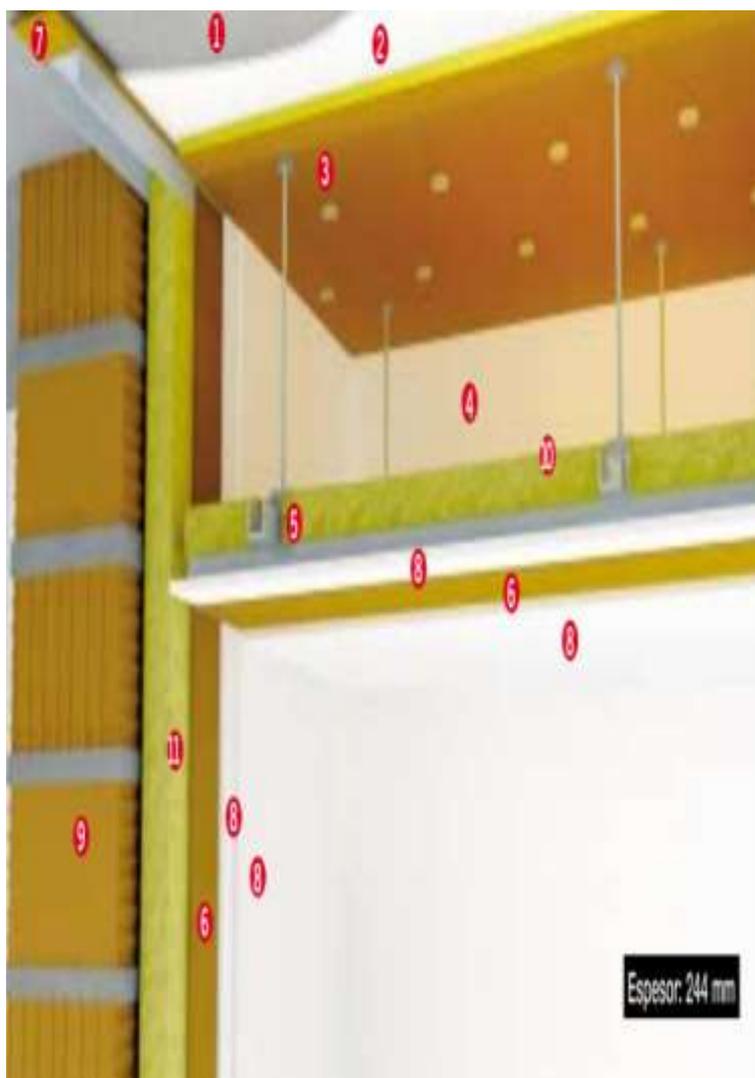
Encuentros de aislamiento con techo y pavimento para espacios interiores
